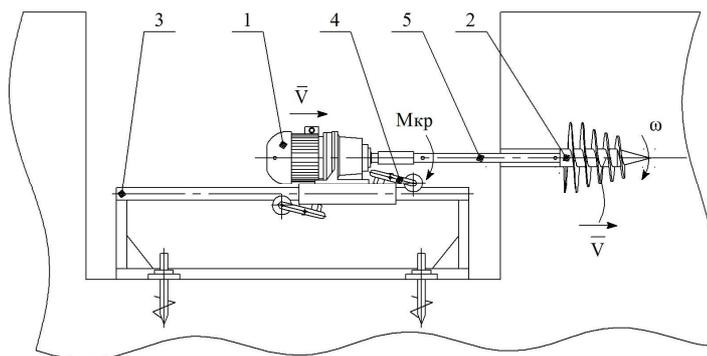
Установка для бестраншейной прокладки коммуникаций : 1 – привод; 2 – винтовой рабочий орган; 3 – продольные направляющие; 4 – роликовая опора. 5 – штанга.
